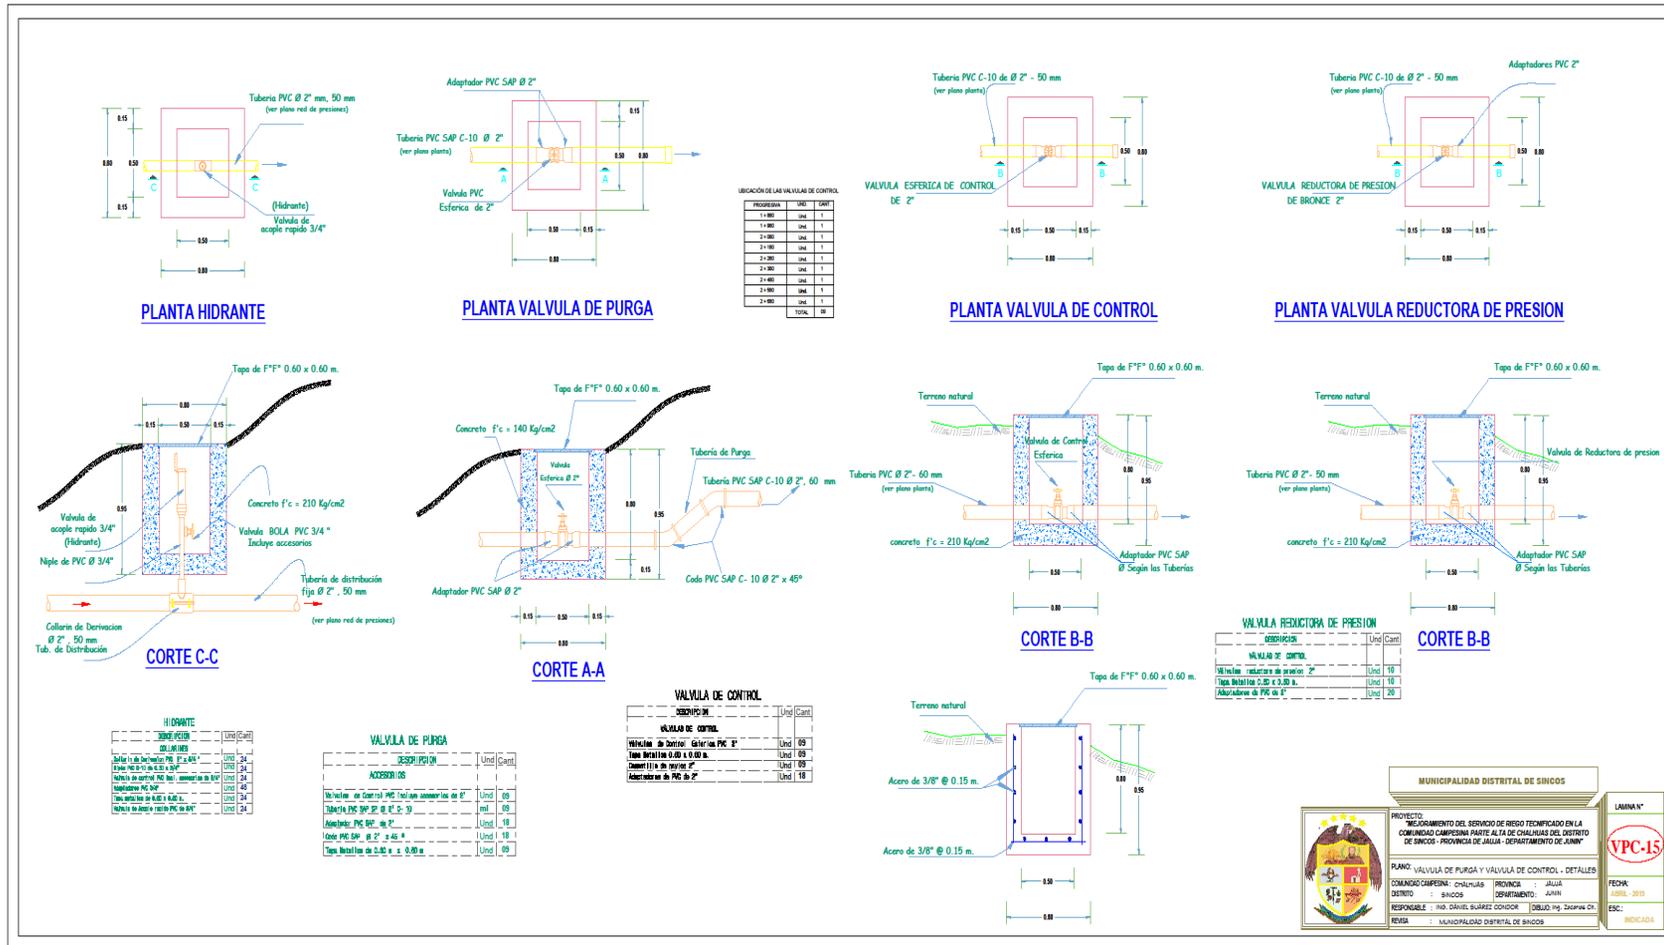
Plano de válvula de purga y válvula de control - detalles.
